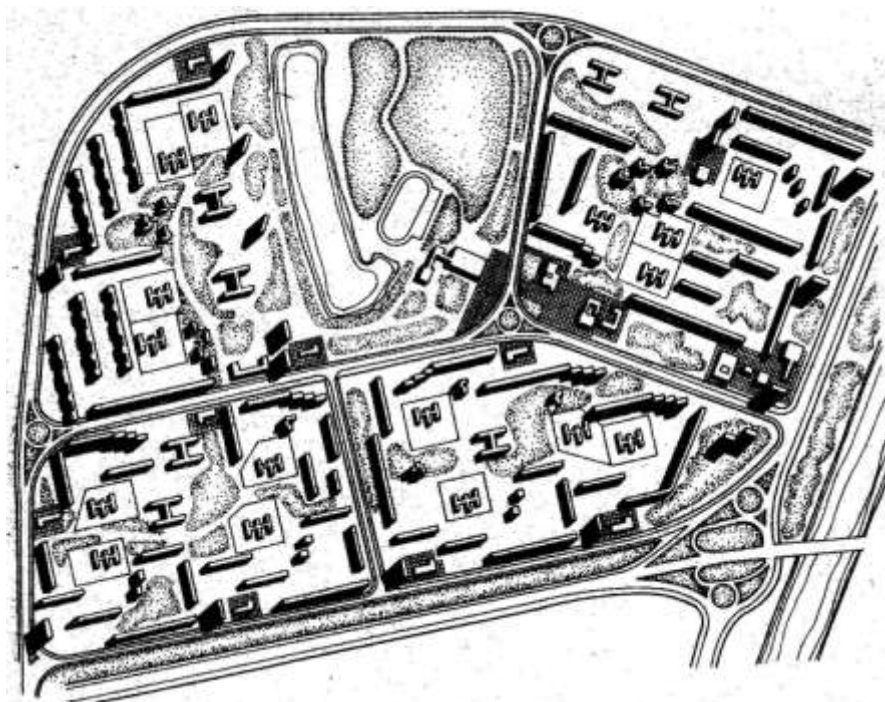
Схема планування та забудови житлового району Березняки (м. Київ)
